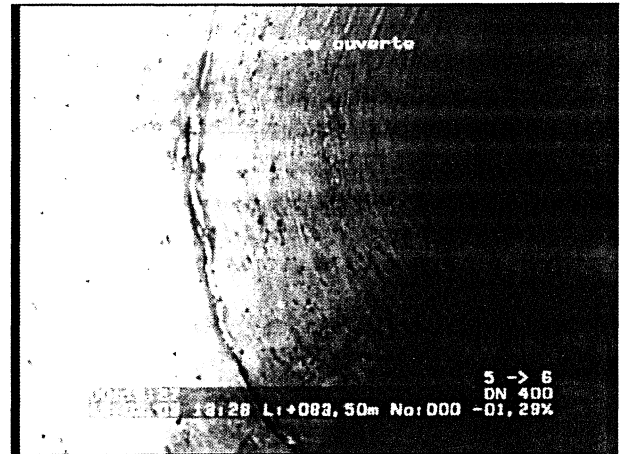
\_13a, N° cassette: 1, 00:18:22
